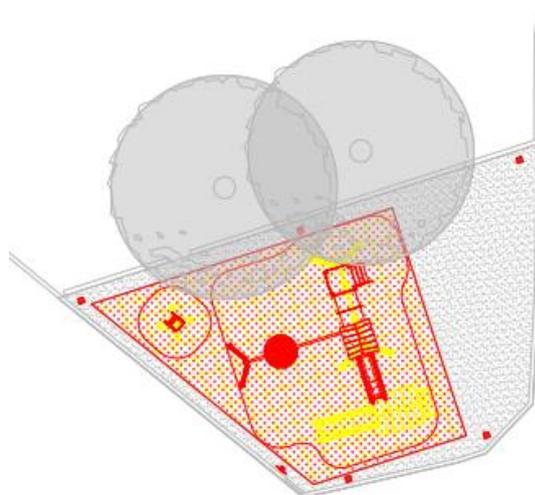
Planta de alterações | Fonte: autora,2023 | sem escala
